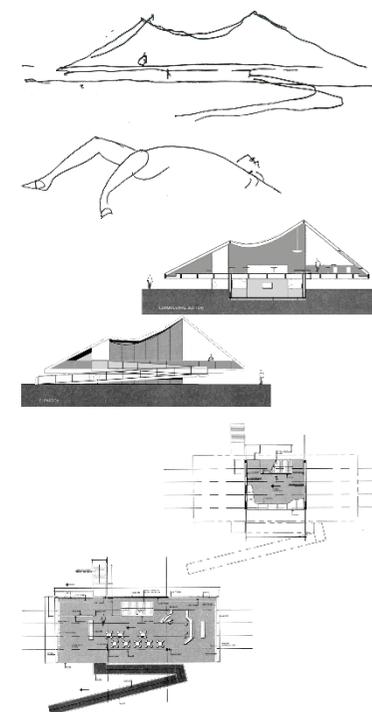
(1ª) Croquis del arquitecto. (2ª) Sección y alzado. (3ª) Planta semisótano y planta principal.
